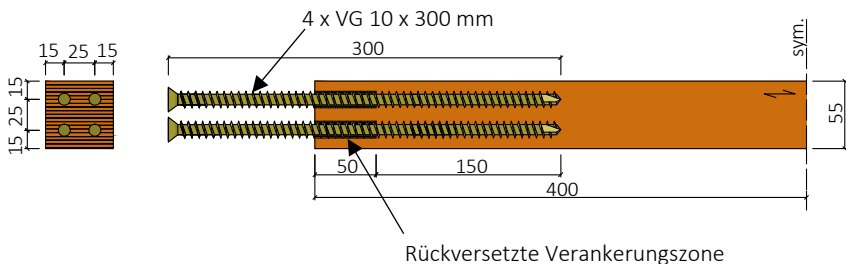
Prüfkörper- und Verbindungsgeometrie der Zugversuche an Schraubengruppen, Maße in mm.
